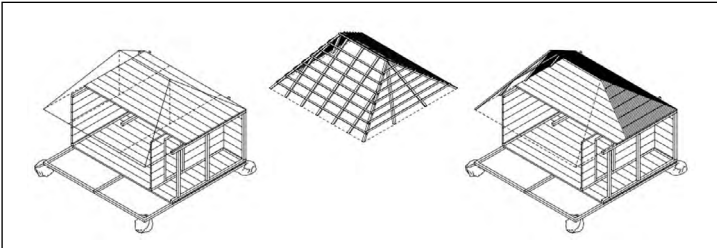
Tapanco, estructura de cubierta, cubierta.
